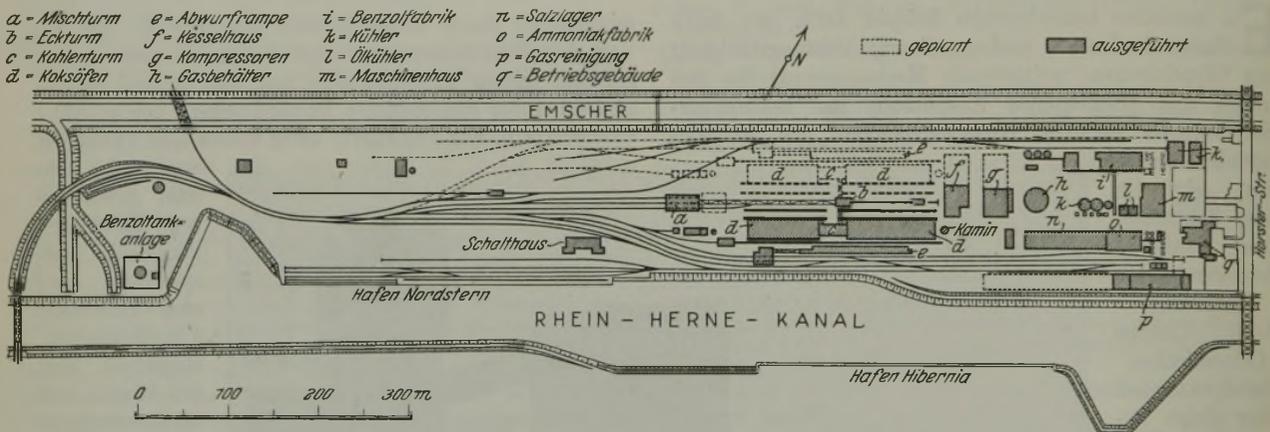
Lageplan der Zentralkokerei Nordstern.
